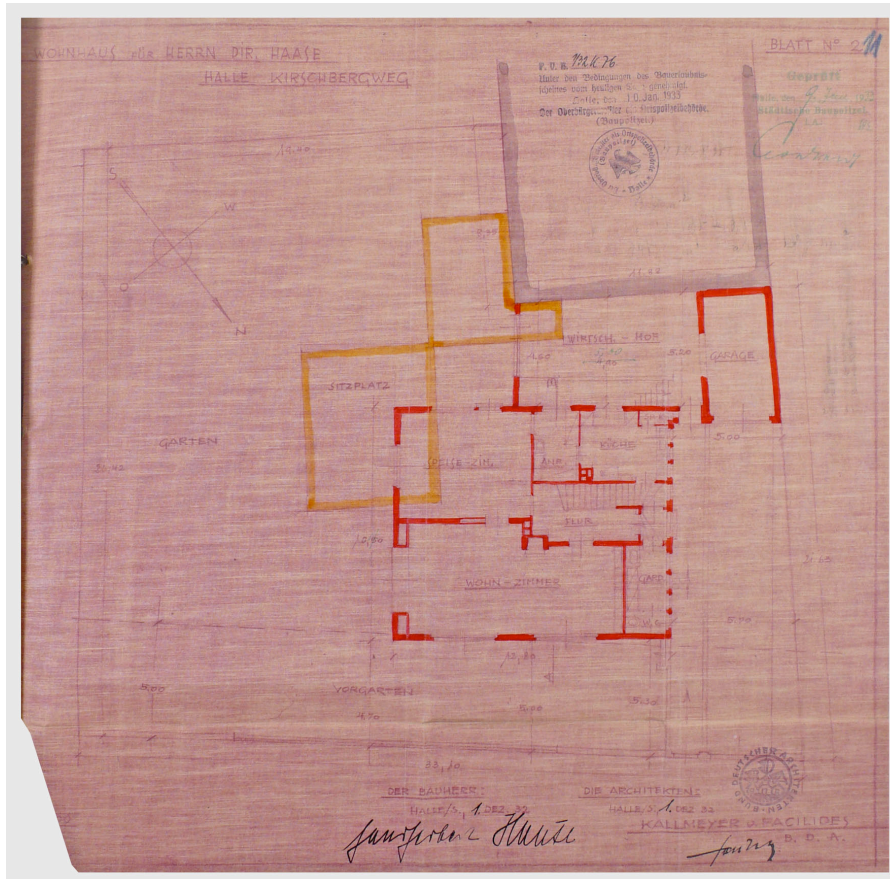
Wohnhaus im Kirschbergweg 3 in Halle, Grundriss Erdgeschoss, 1. Fassung, datiert 1. Dezember 1932.
